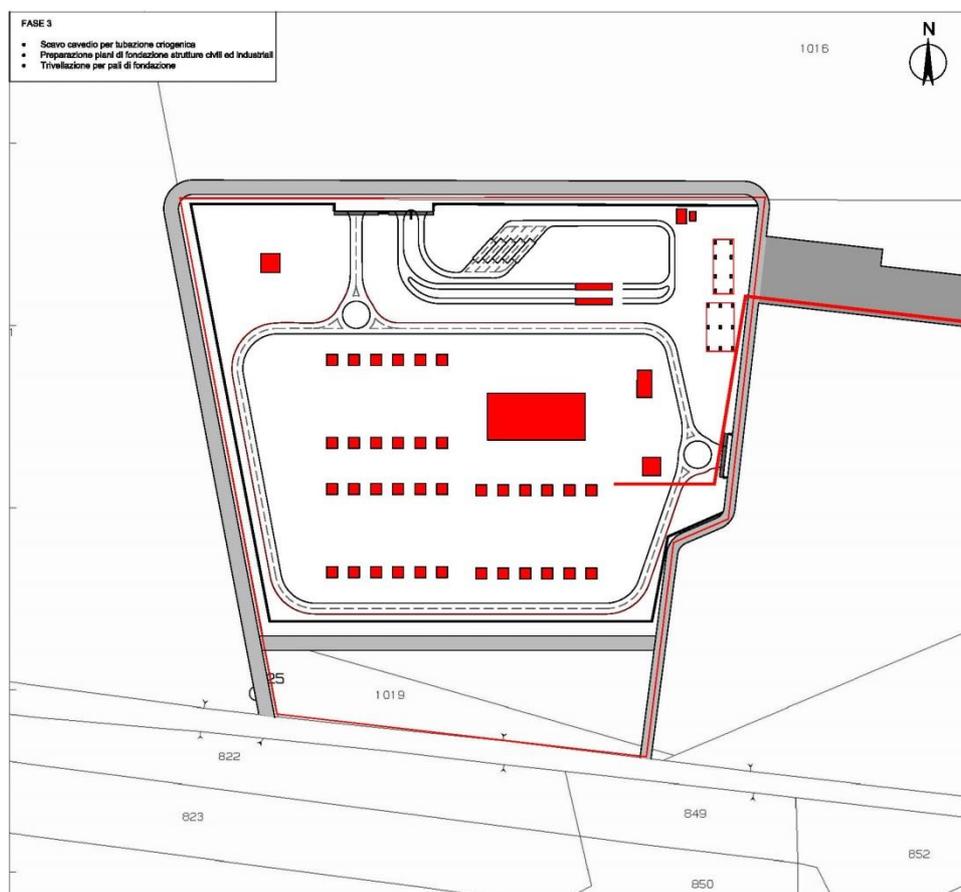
Fase 3. Area oggetto delle lavorazioni previste.
